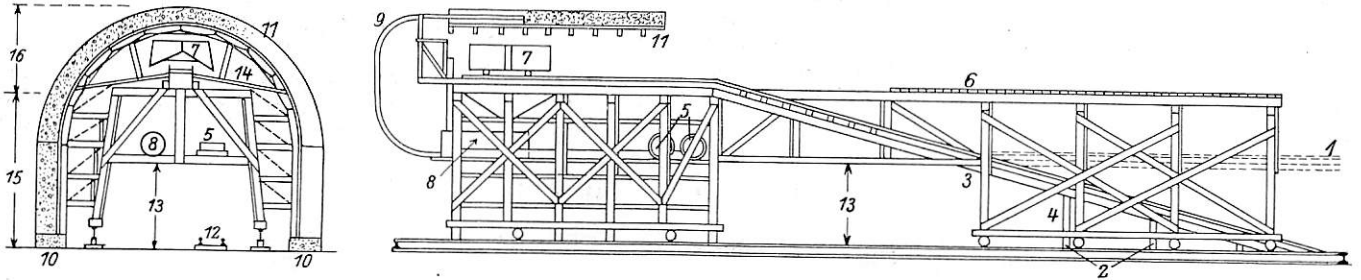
Vorrichtung zum Ausbetonieren der Tunnelwände.
